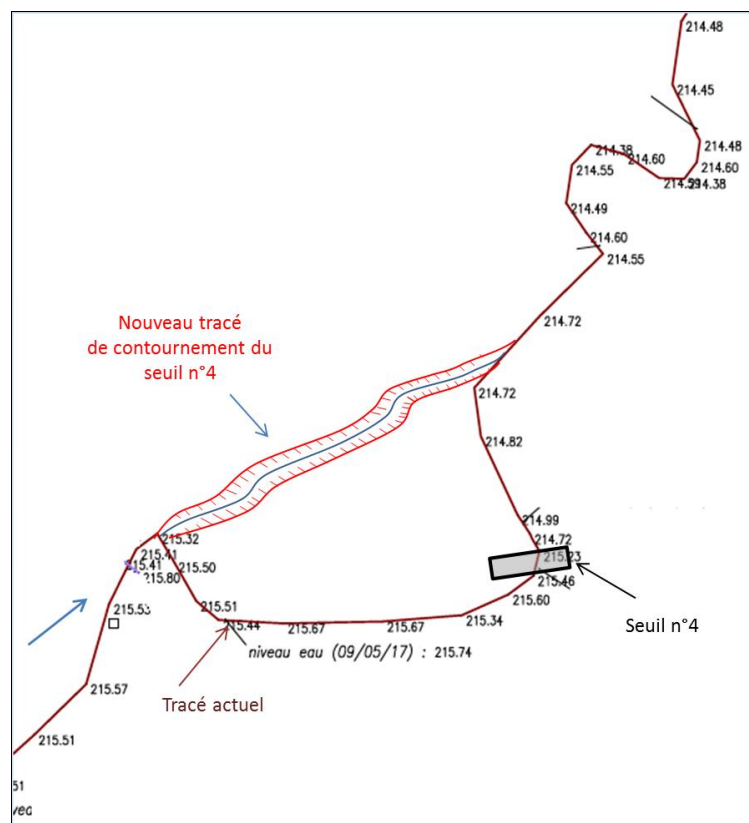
Vue en plan du contournement de l'ouvrage n°4
